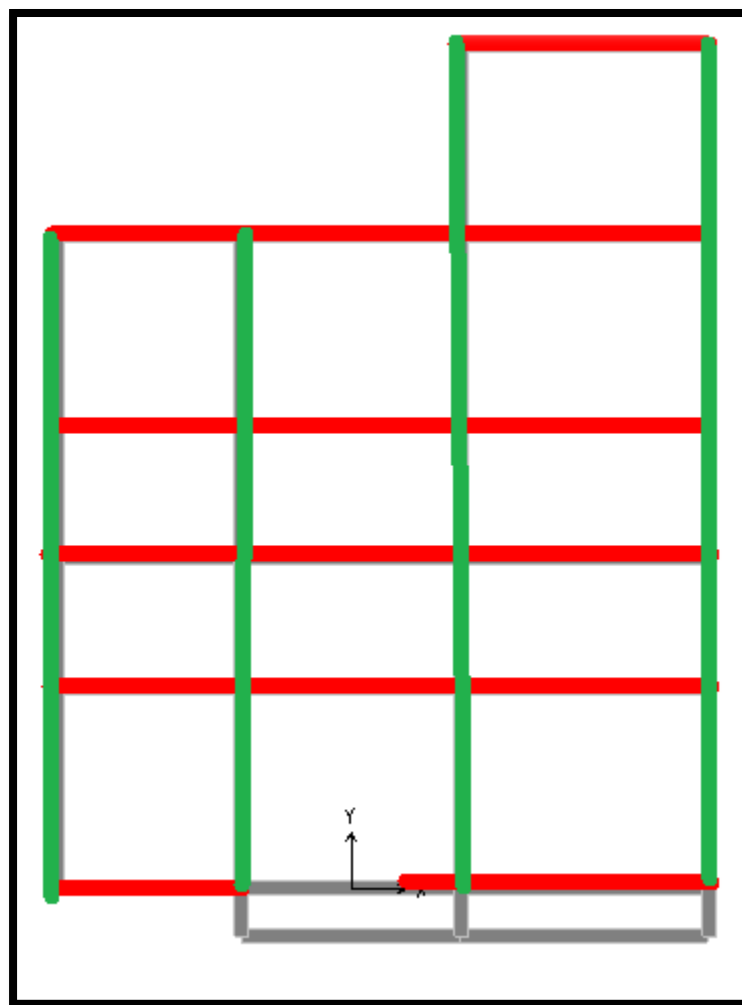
Vérification du ferrailage des poutres principales et des chaînages ($Z=4.05$ m)
